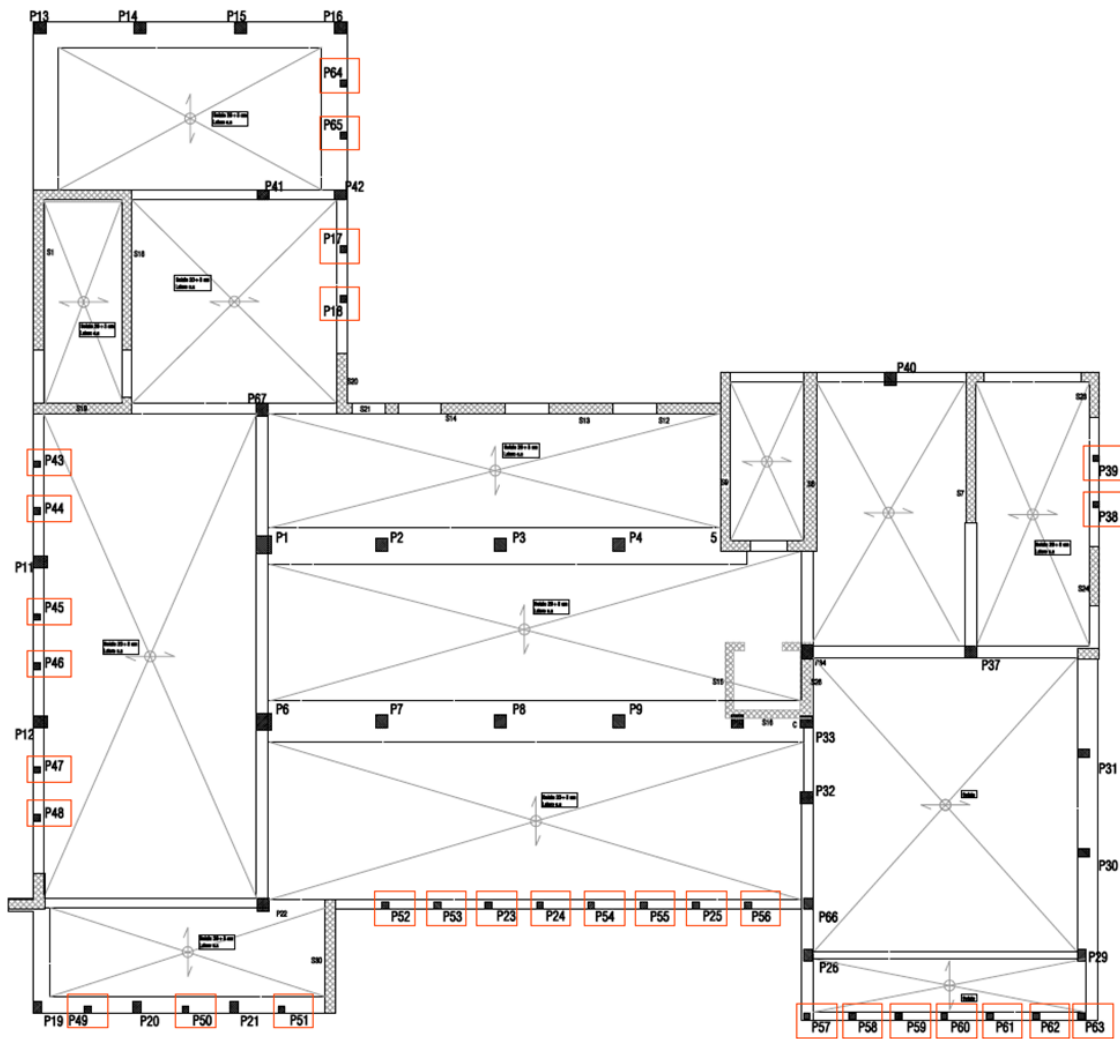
Pilastrì piano primo, nel riquadro in rossi pilastrì non verificati allo SLU
